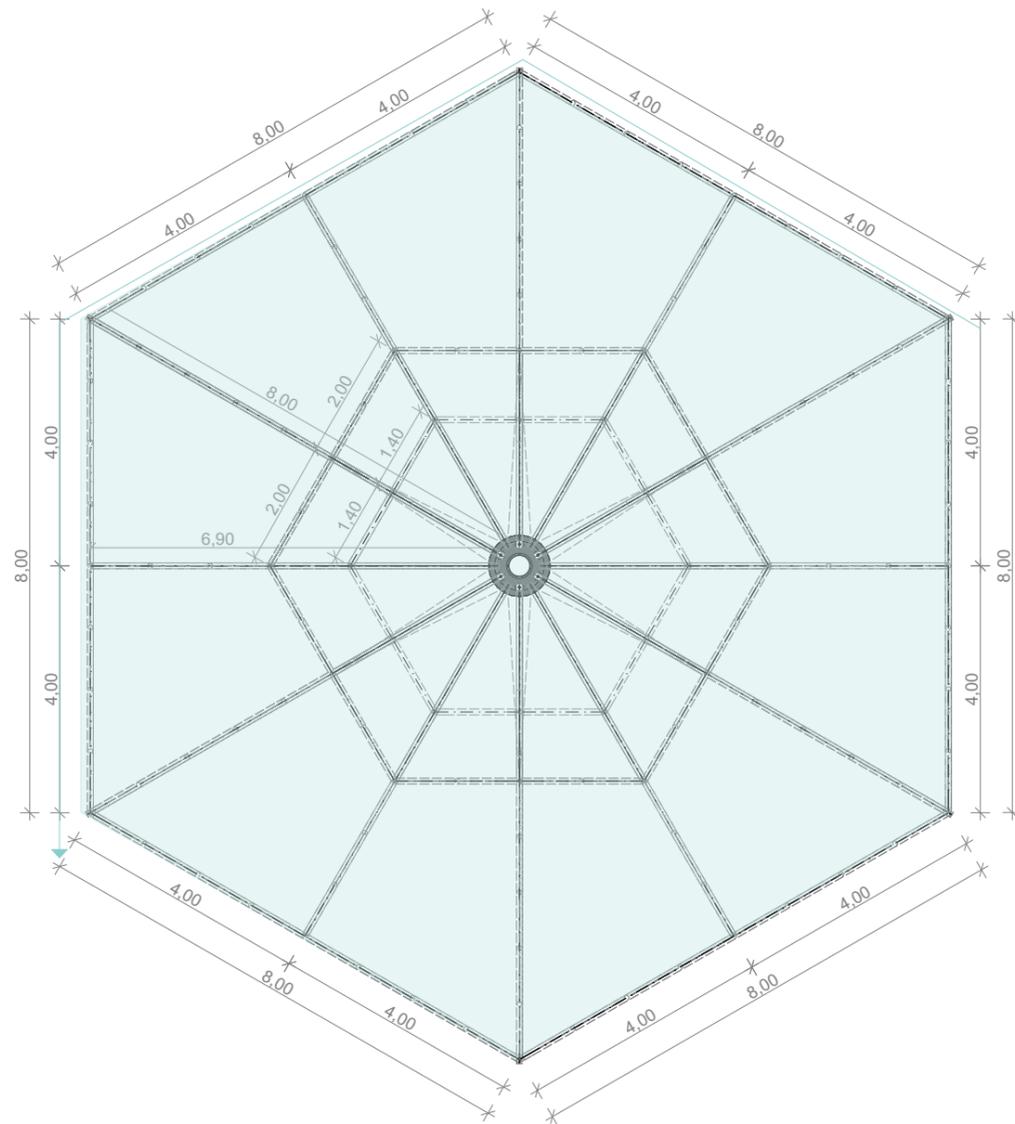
Grundriss Tragwerk Trichterform
